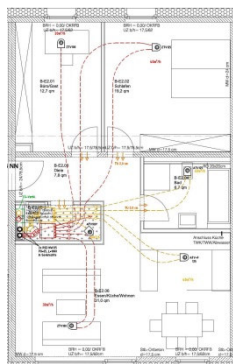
Grundriss einer Beispielwohnung
